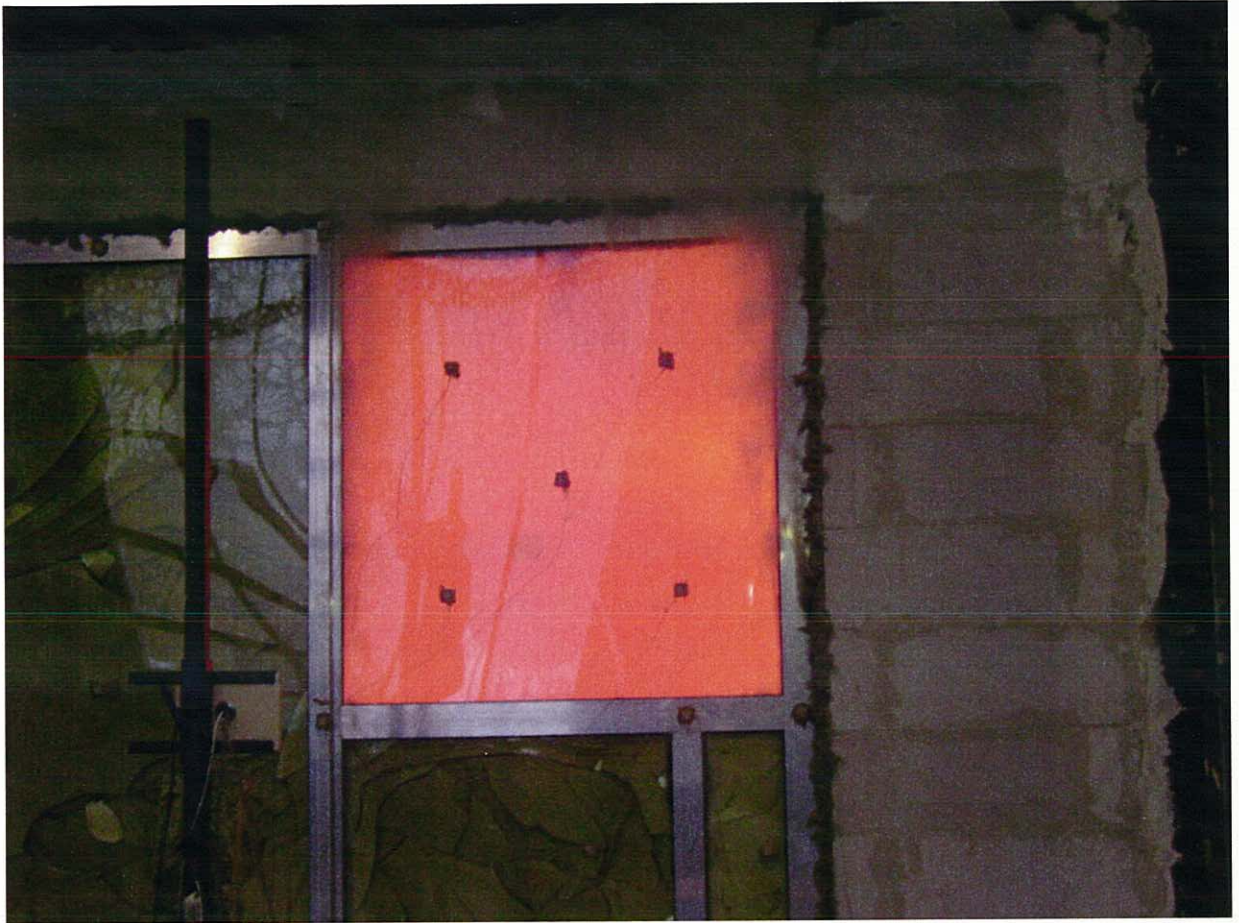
aanzicht van de constructie na 43 minuten verhitting.
